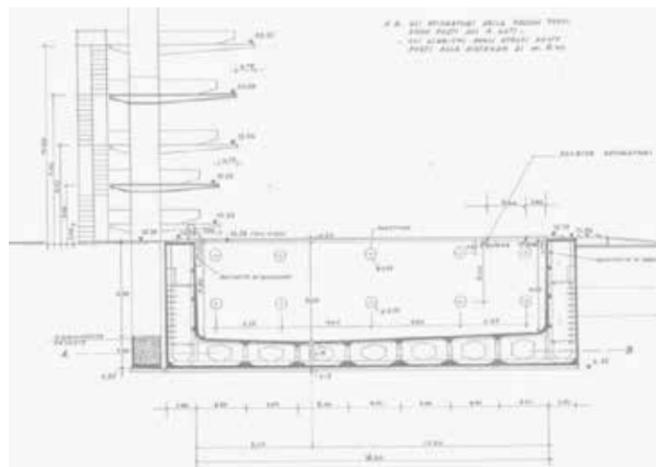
Sezione di progetto della piscina tuffi e del trampolino
